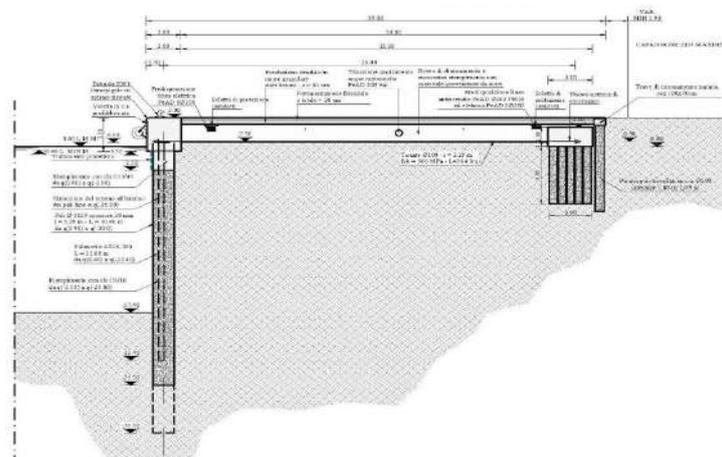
Sezione tipo banchina tratto prospiciente il capannone
